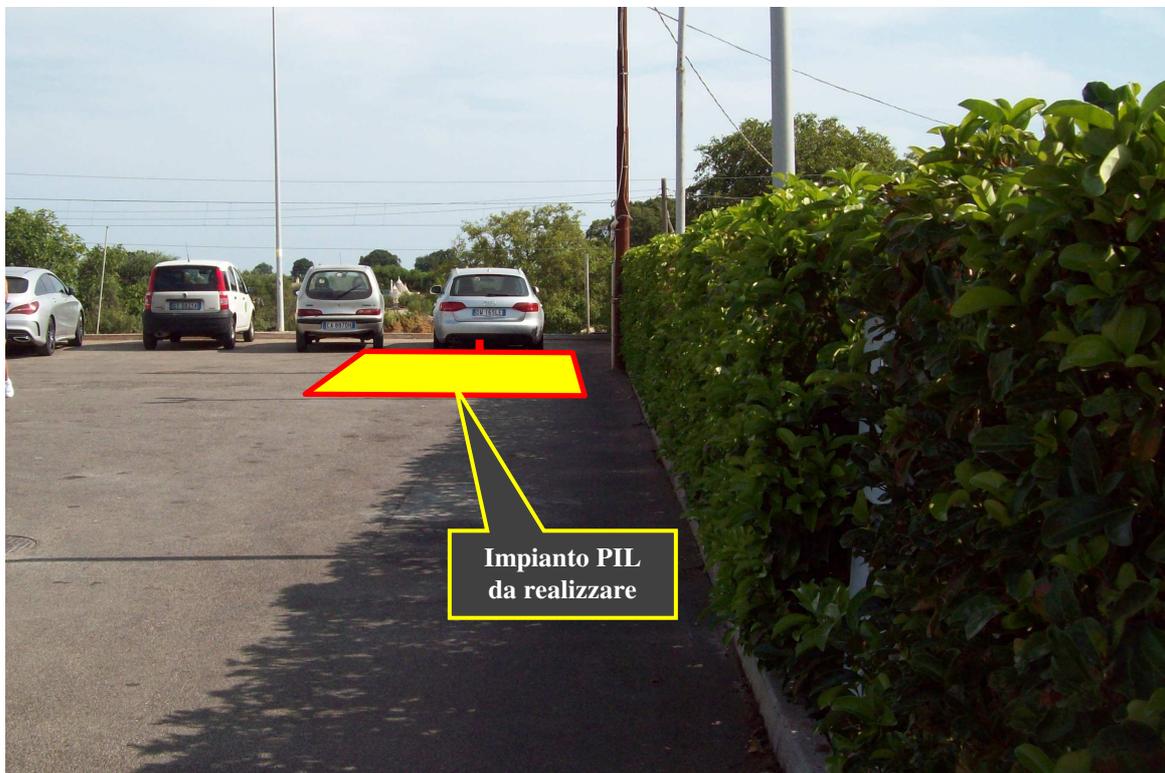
Tratto finale con ingresso all'impianto PIL terminale in area di servizio
